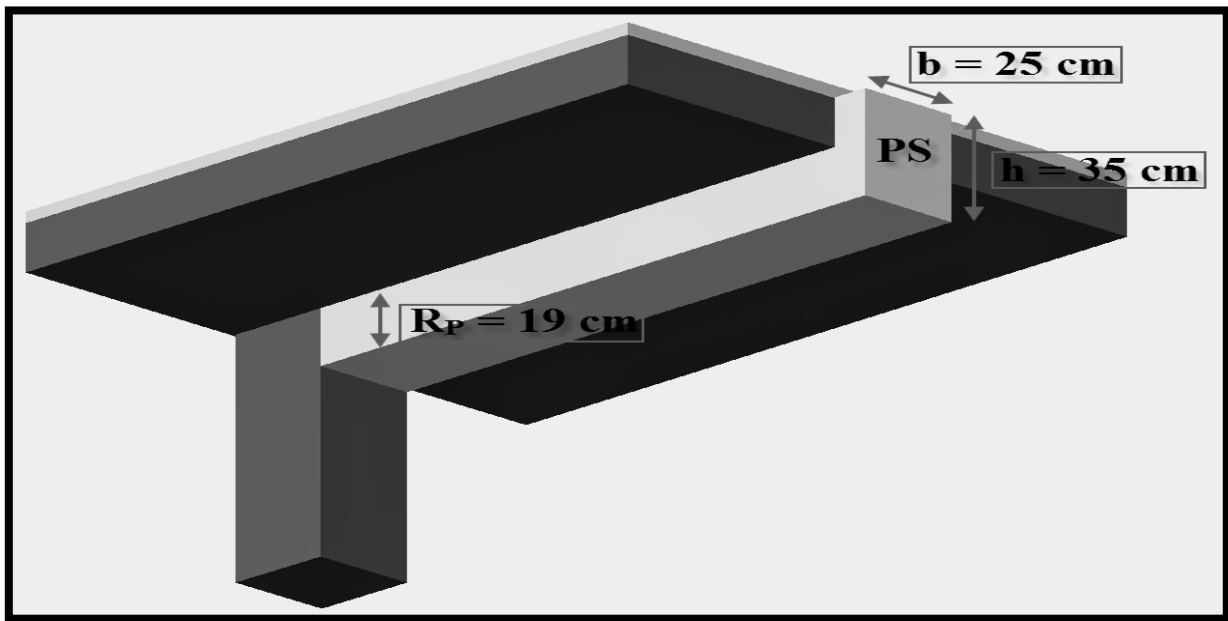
Schématization (3D) des poutres secondaires pré-dimensionnées.
